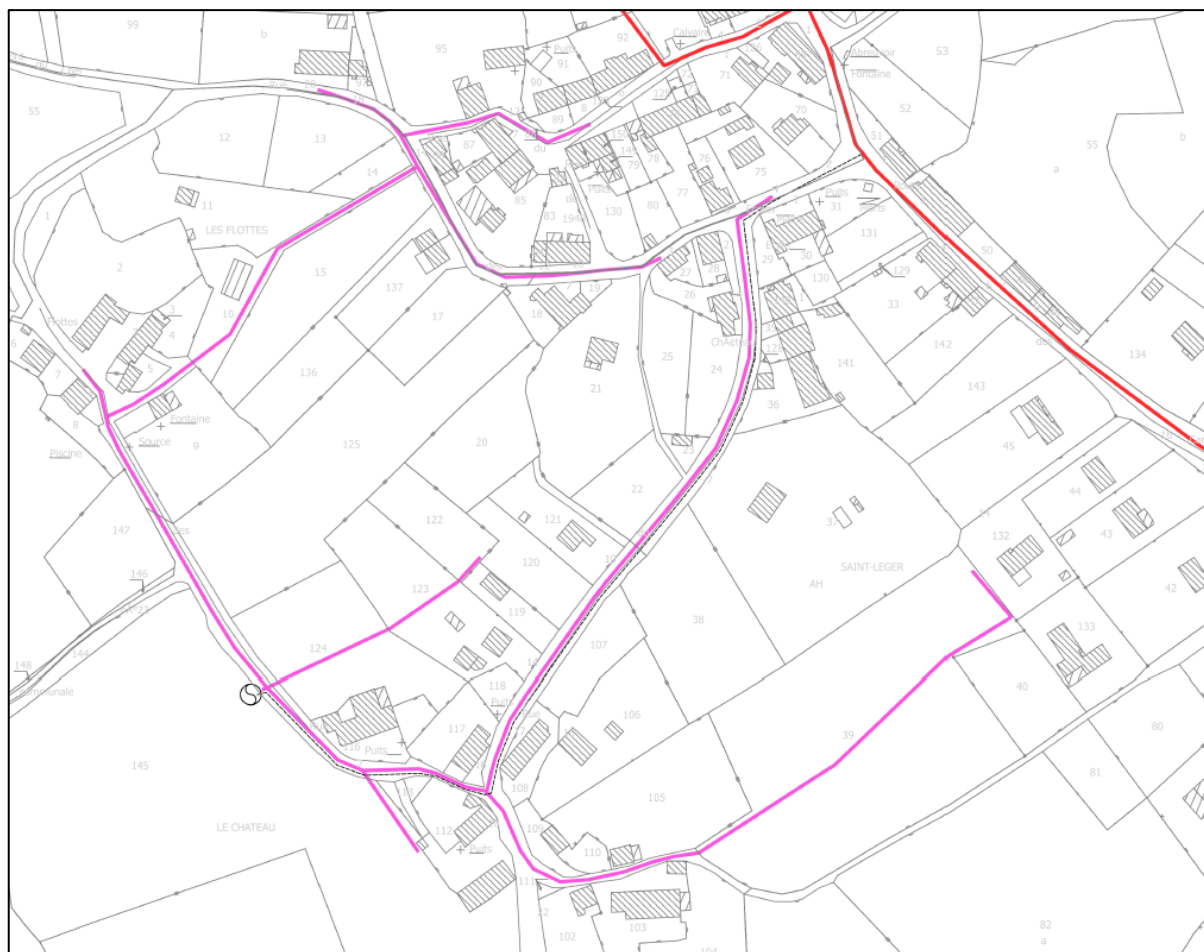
projet d'assainissement collectif sur les secteurs du Château-les Flottes
